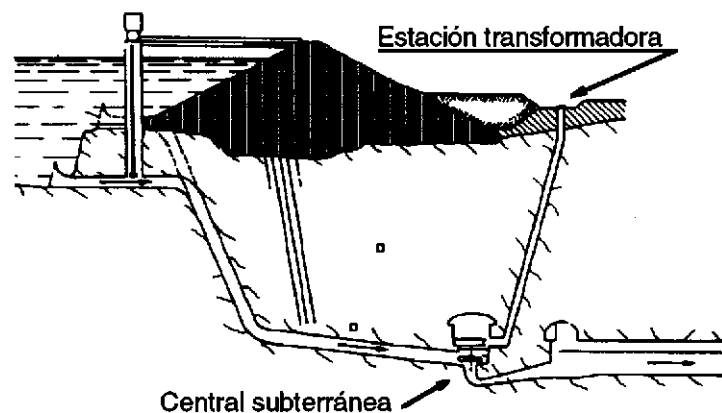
Corte esquemático de una central subterránea.
